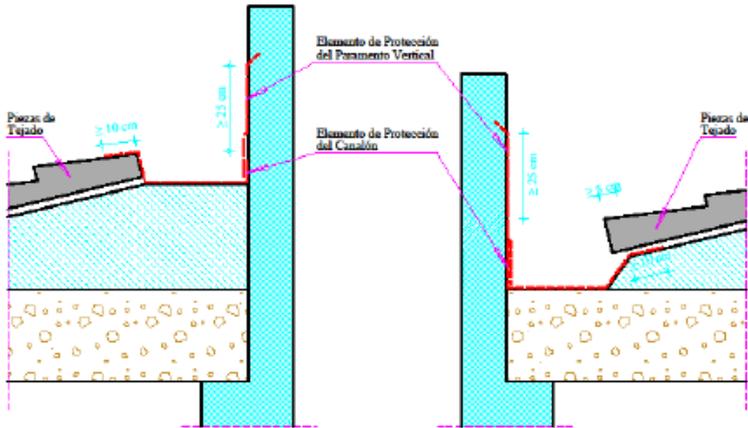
Encuentro de la cubierta con canalón. Fuente CTE
